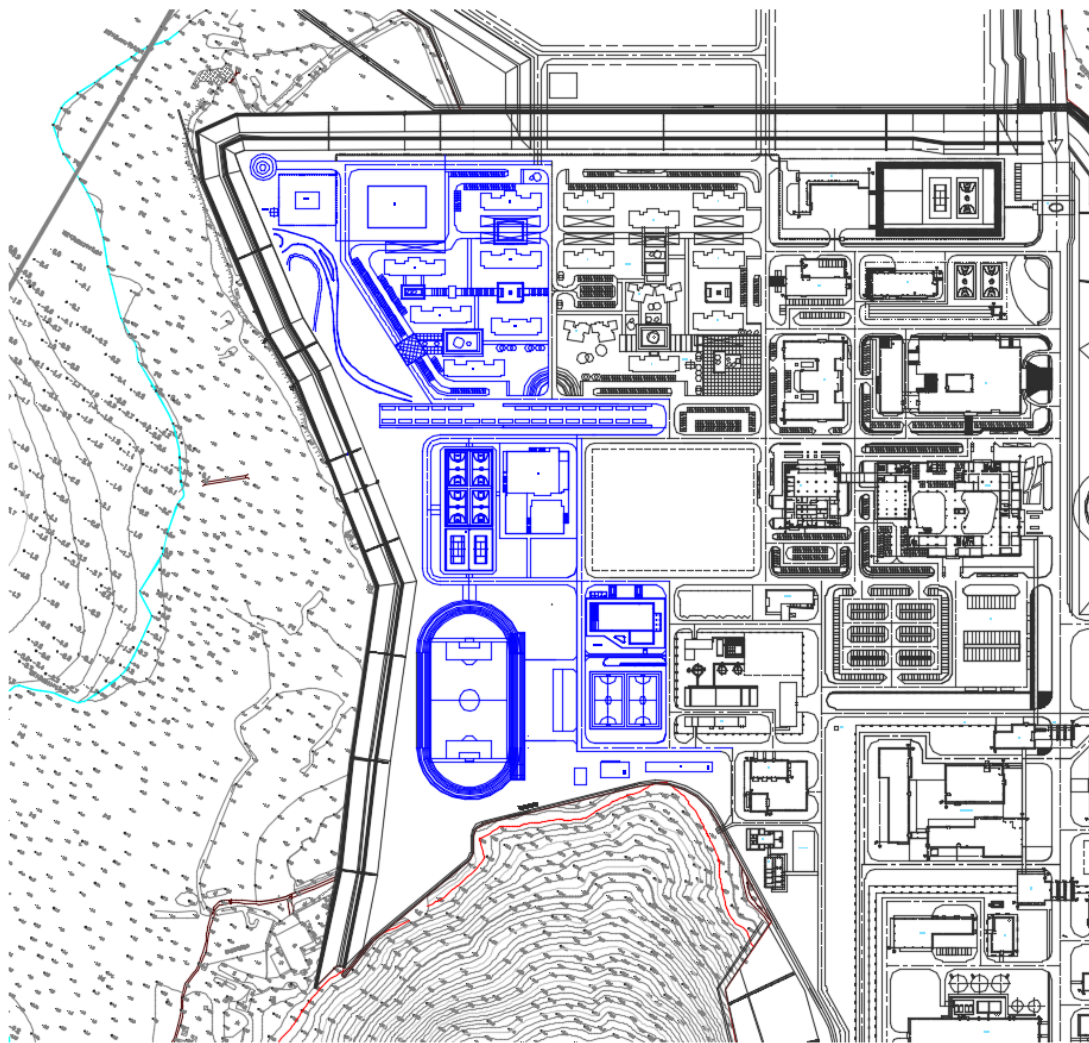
本期厂外辅助设施及现场服务区平面布置图
